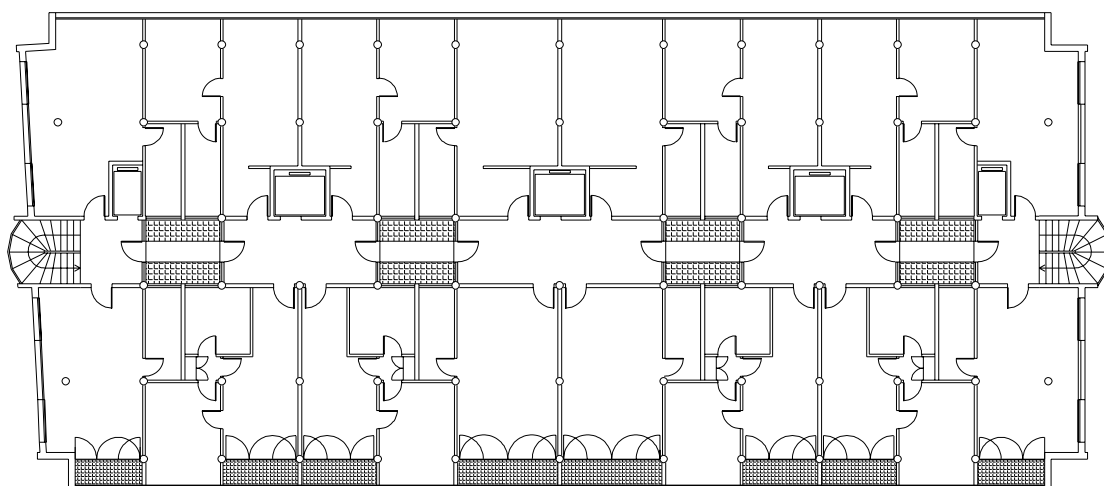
Planta do quarto pavimento. O corredor central é a base dos vazios que 'cortam' o prédio.
